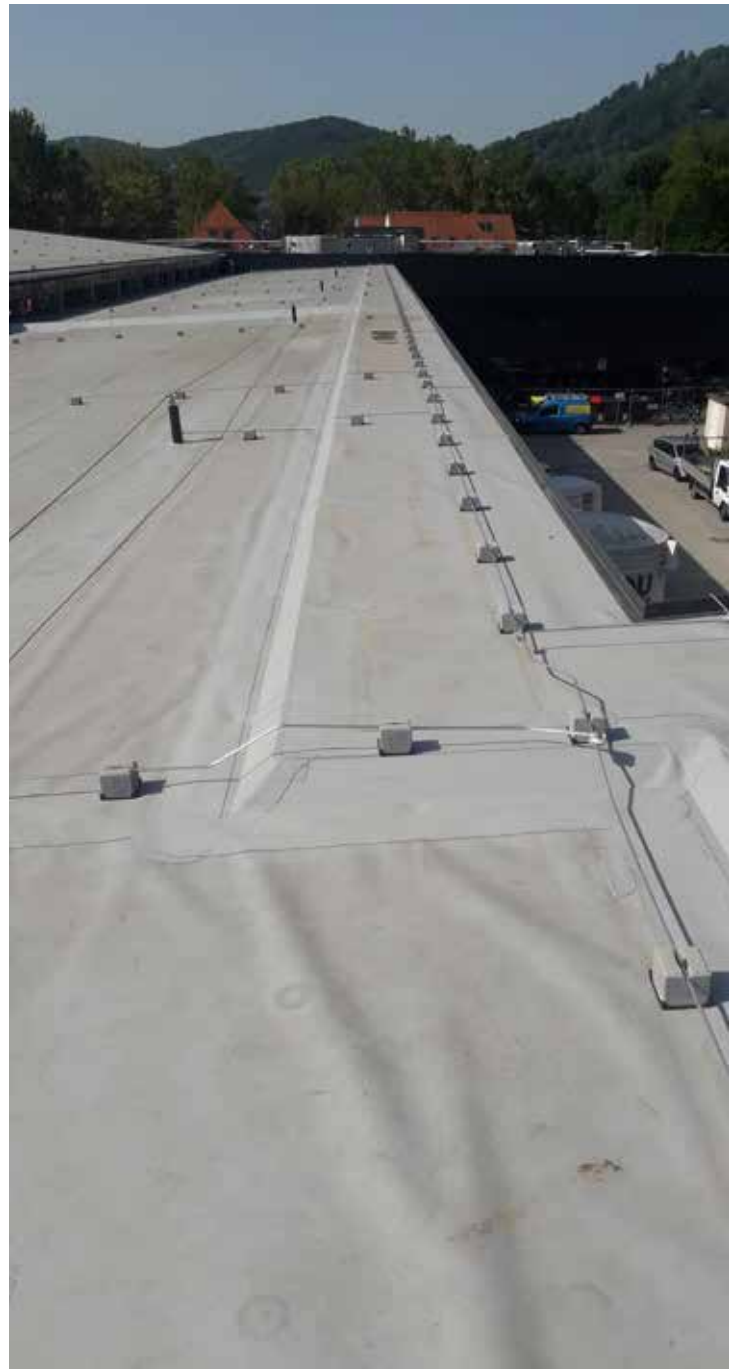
Sarnaweld-Befestigungen in Beton
